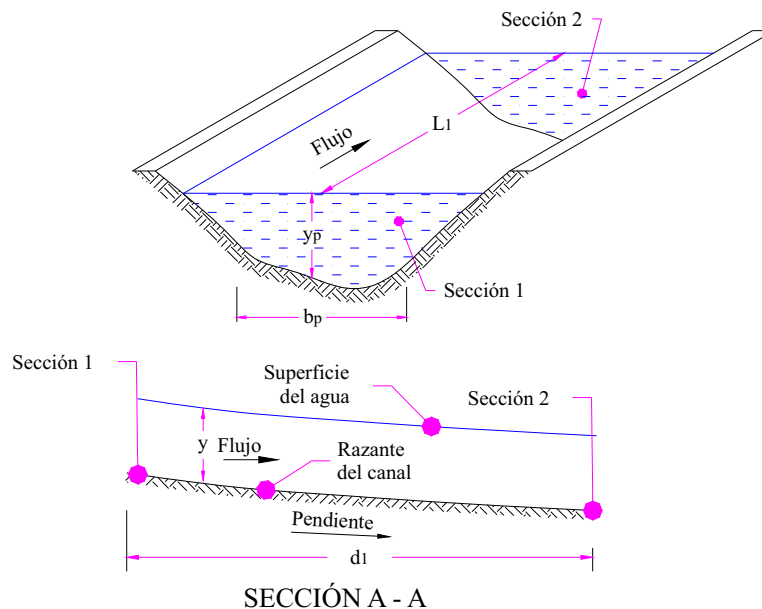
Sección y Perfil de Canal en Tierra
